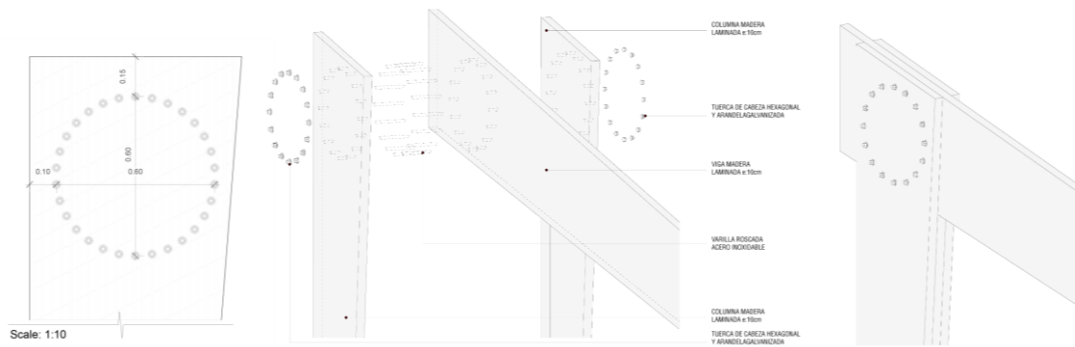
Unión columna y viga laminada – anillo rigidizador
